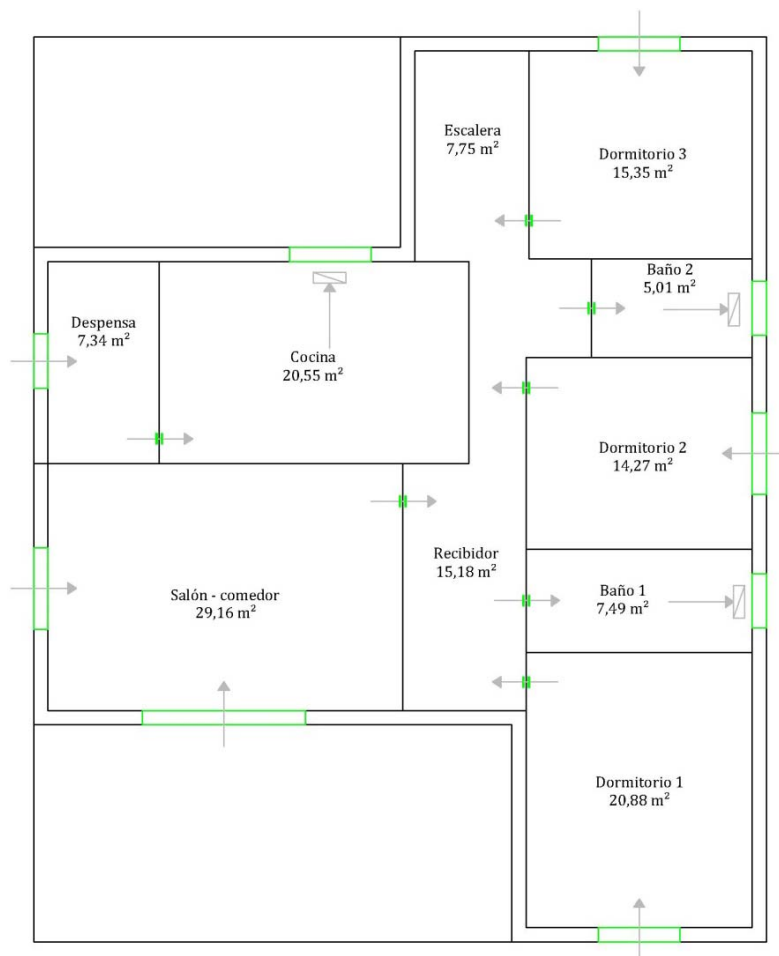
Croquis de particiones para las renovaciones de aire en la planta baja
